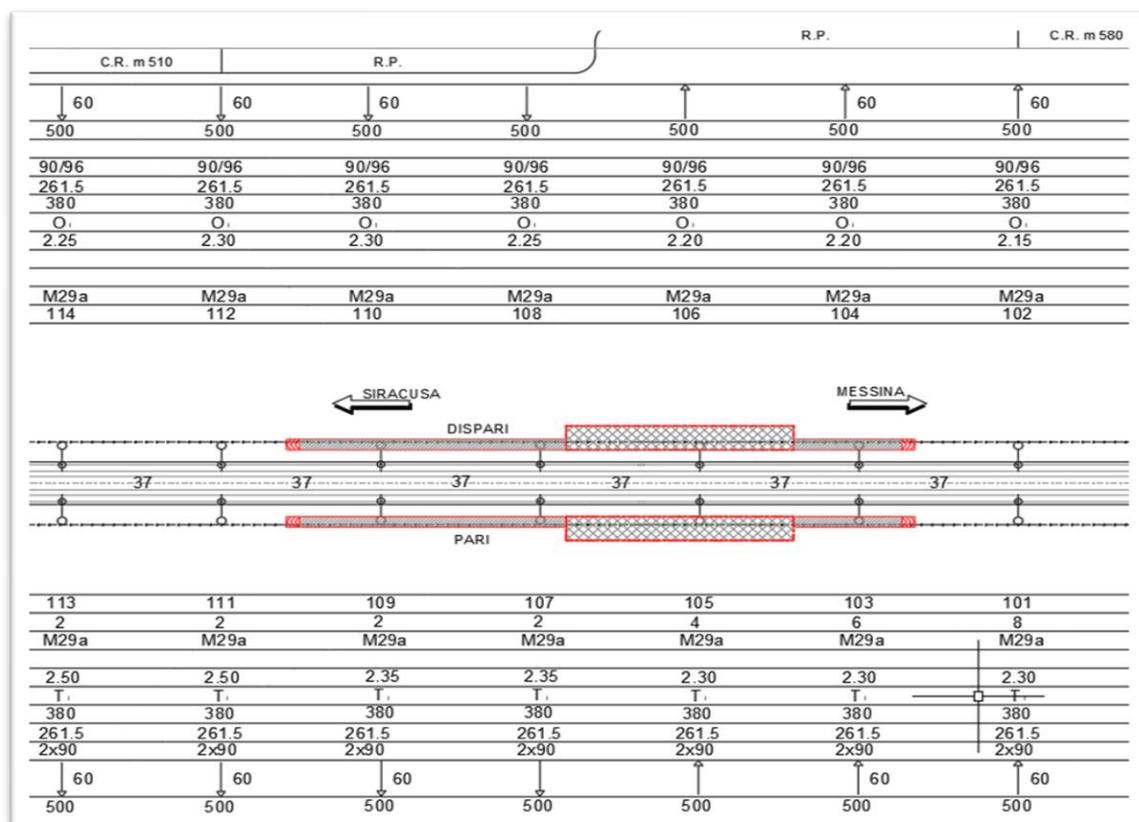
Stralcio PdE con evidenza posizione banchine Nuova Fermata Acireale e Pensilina
